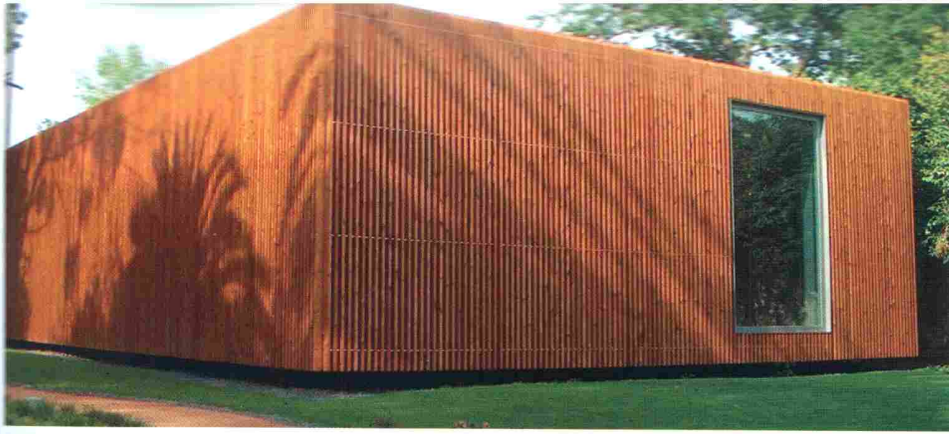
Madeira termicamente modificada aplicada como revestimento exterior de fachada.
